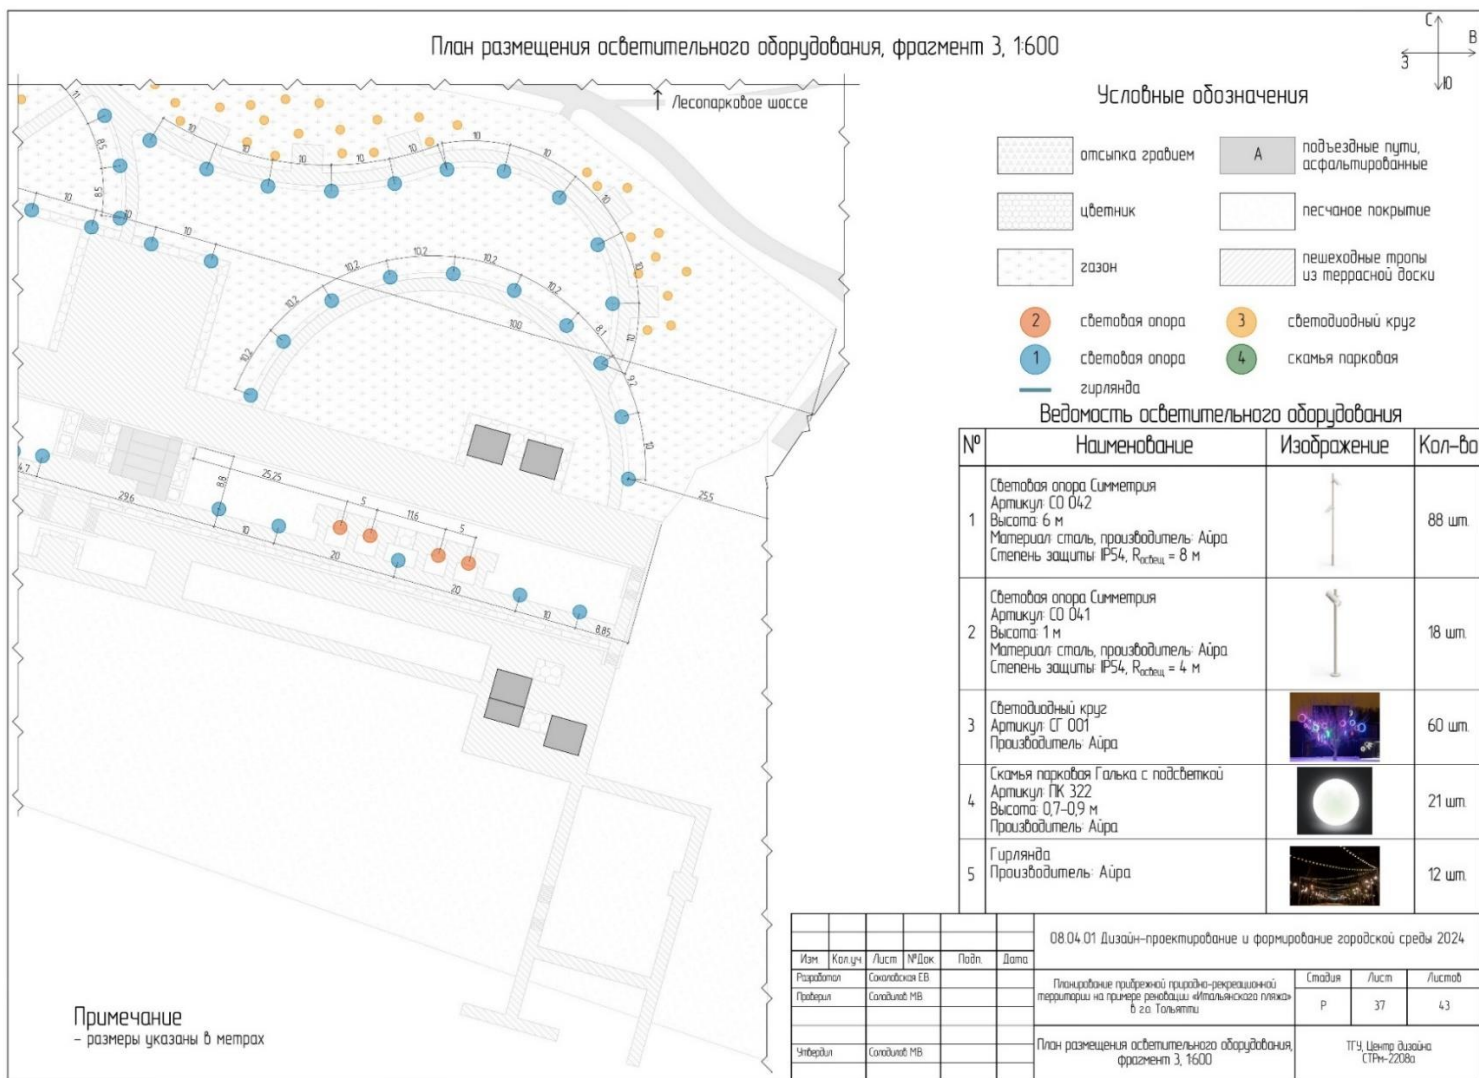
План размещения осветительного оборудования, фрагмент 3
